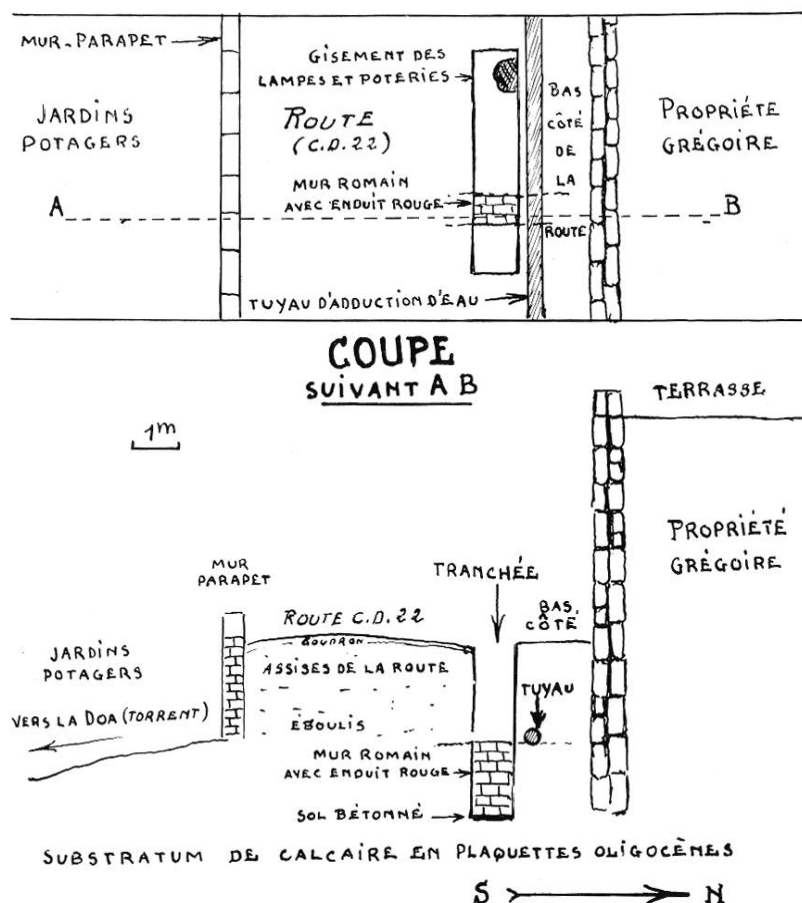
Apt. Plan et coupe de la fouille de 1956.
